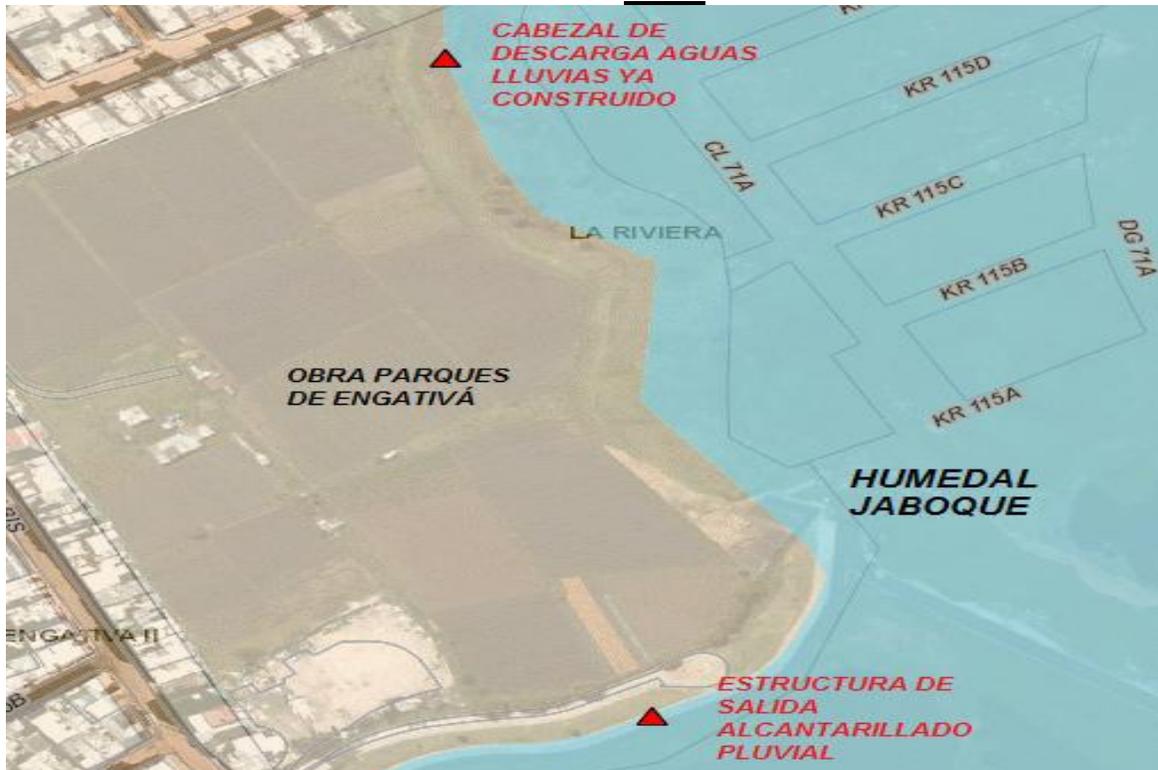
Plano de las obras de acueducto pluvial construidas en la obra Parques de Engativá. Calle 116 B
